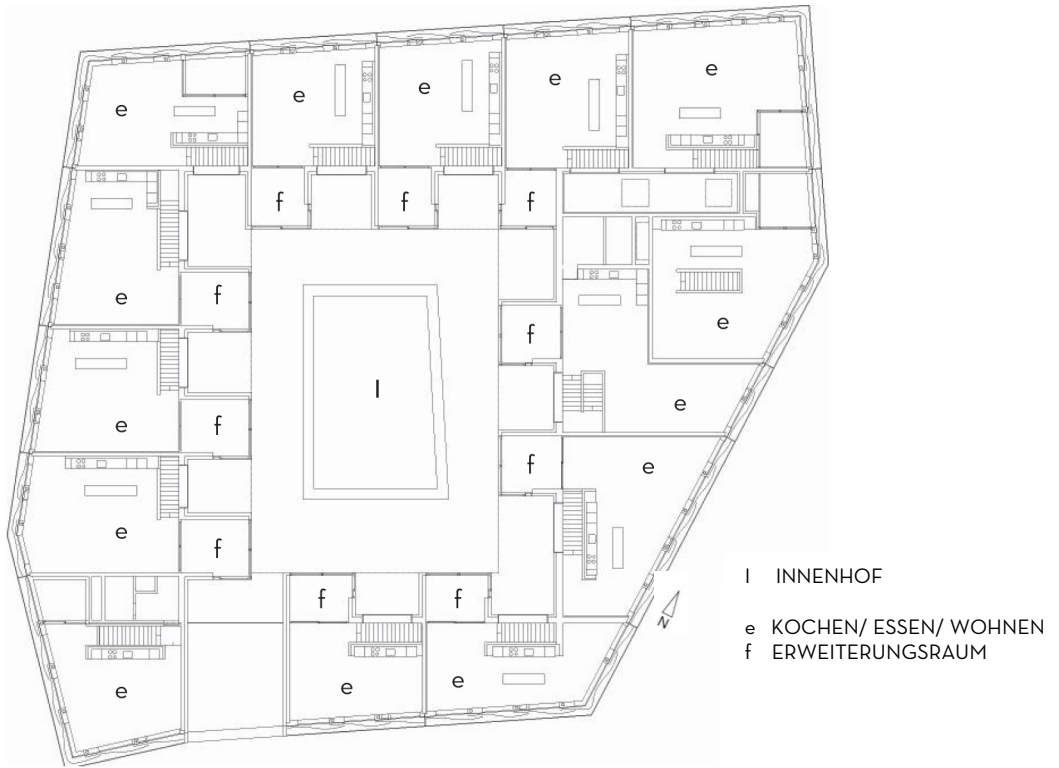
Detail Wohngrundriss 5. Obergeschoss M 1:500
